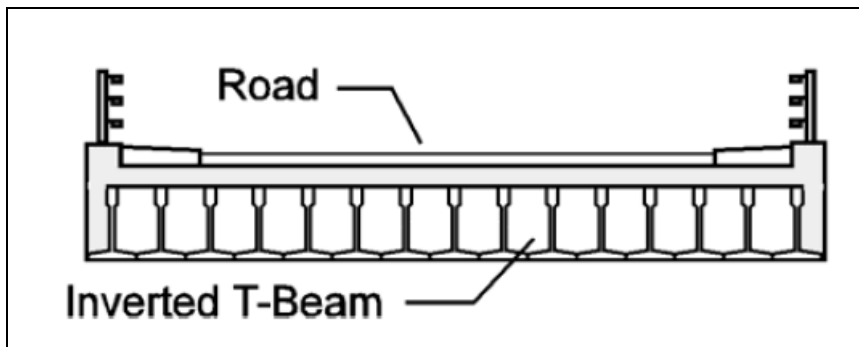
Jenis 8, Pre-cast reinforced concrete beam
